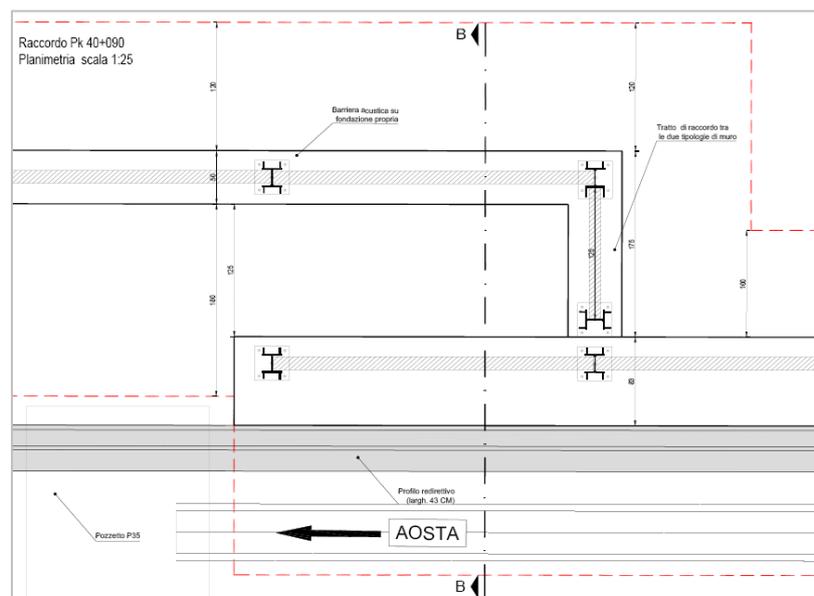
/4 Tratto di raccordo fondazioni tipo 1-tipo 2 alla progressiva 40+090 – Pianta
